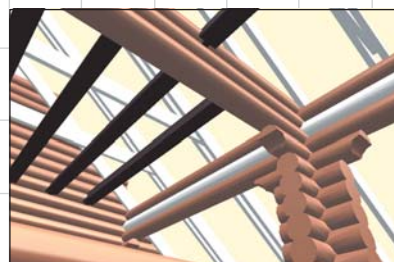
Фрагмент стропильных конструкций и балок перекрытия
